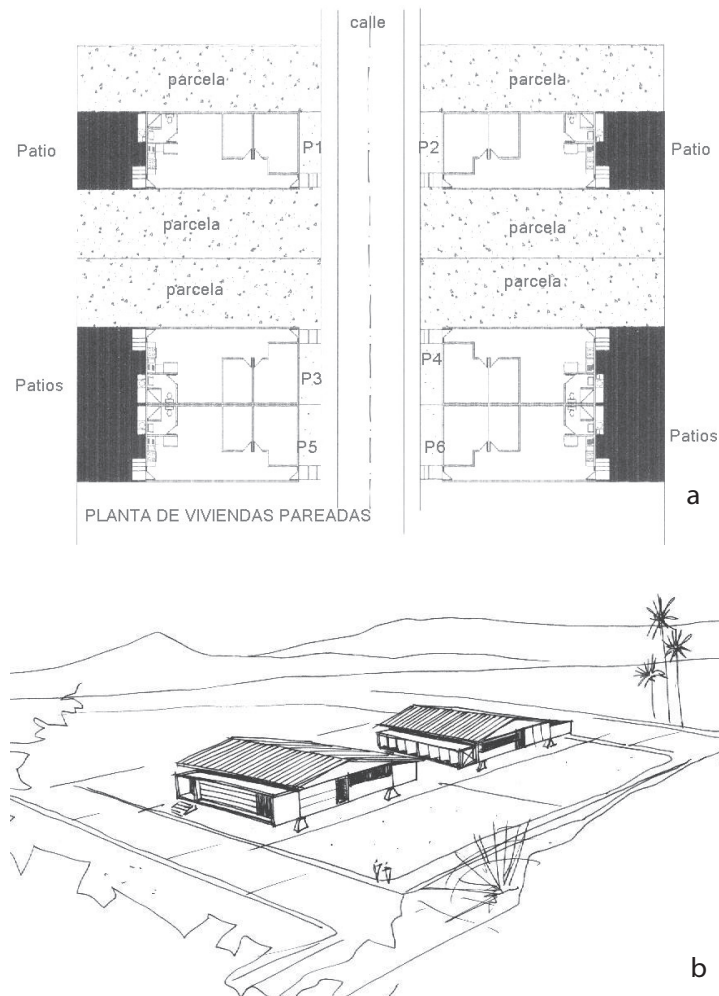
(a) Vista de planta de las viviendas en un urbanismo de parcelas de 5 metros por 20 metros de largo; (b) Las viviendas prefabricadas están sobre pilotes de hormigón armado de altura 0,70 centímetros. Su crecimiento futuro está propuesto sobre el terreno firme y colinda con la otra vivienda.
